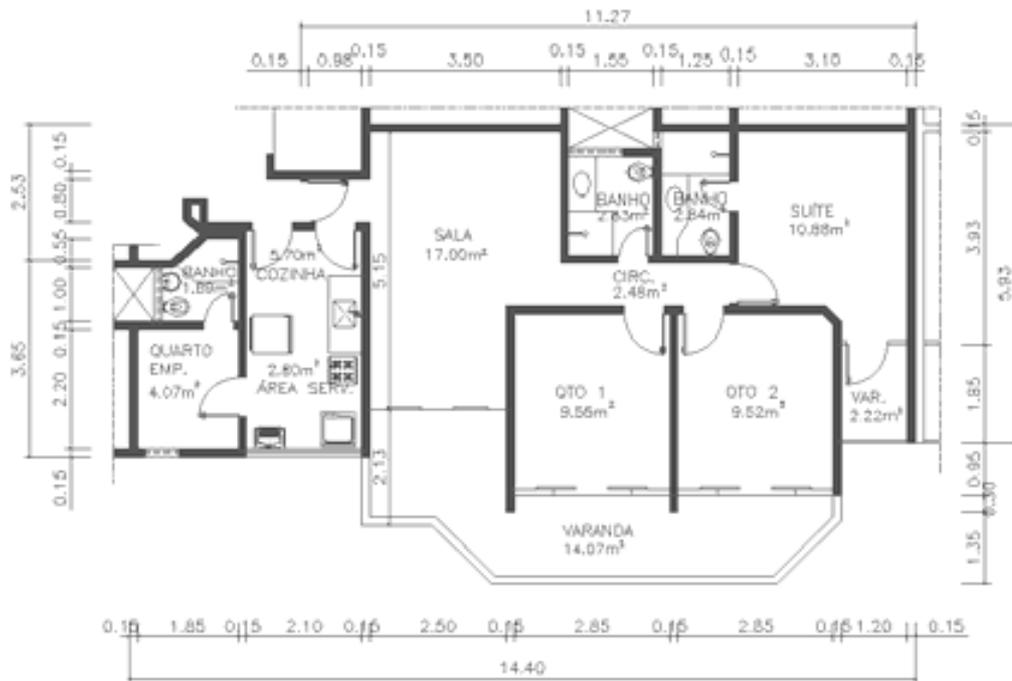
SQSW 304 – BLOCO C - Planta original
